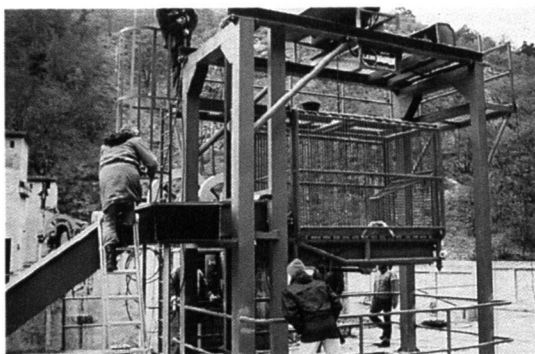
Cuve en position haute, dispositif de levage de Poutès sur l'Allier (Haute-Loire).
